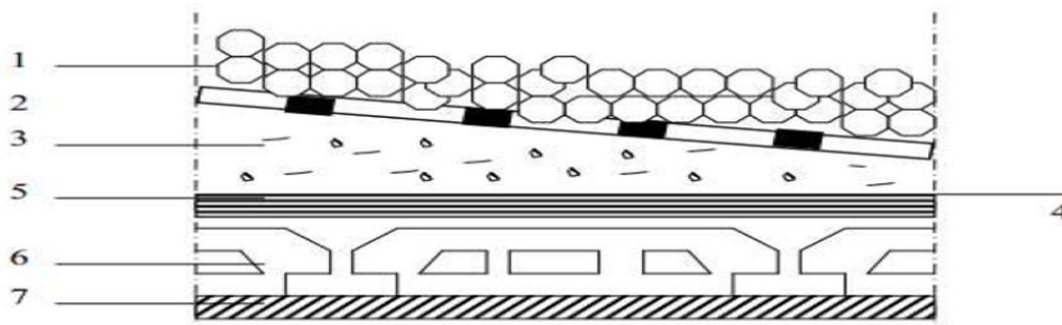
Coupe verticale du plancher terrasse inaccessible
